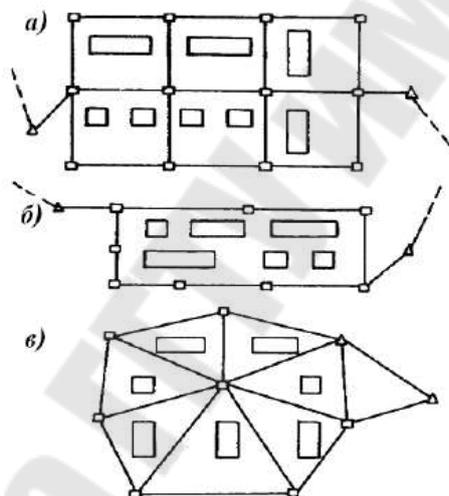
Схема разбивочной сети строительной площадки
